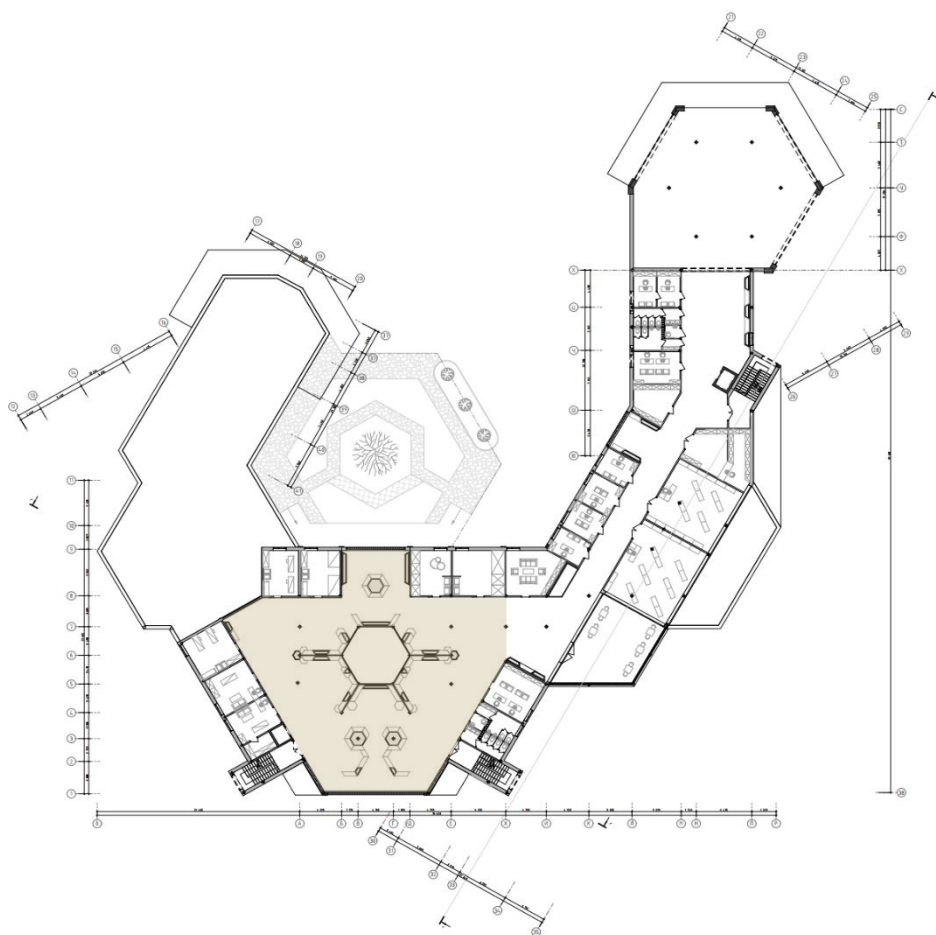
Розташування приміщення холу на плані 2-го поверху
